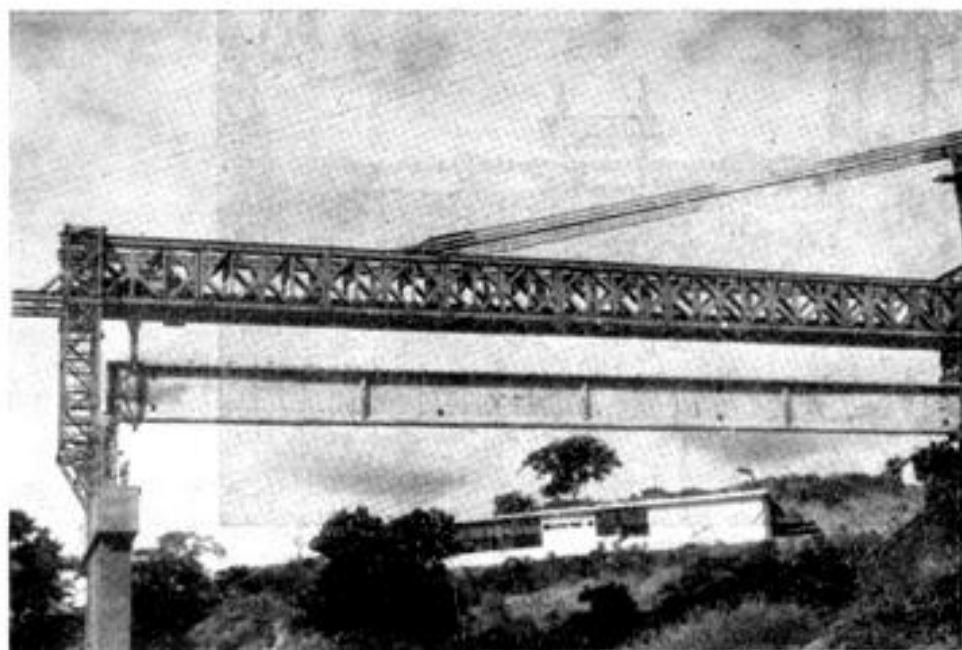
Carro de transporte transversal sôbre os pilares em primeiro plano, cavalete central da treliça
